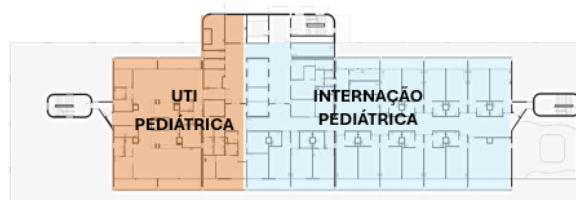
SETORIZAÇÃO BLOCO 1 - 4º PAVIMENTO
